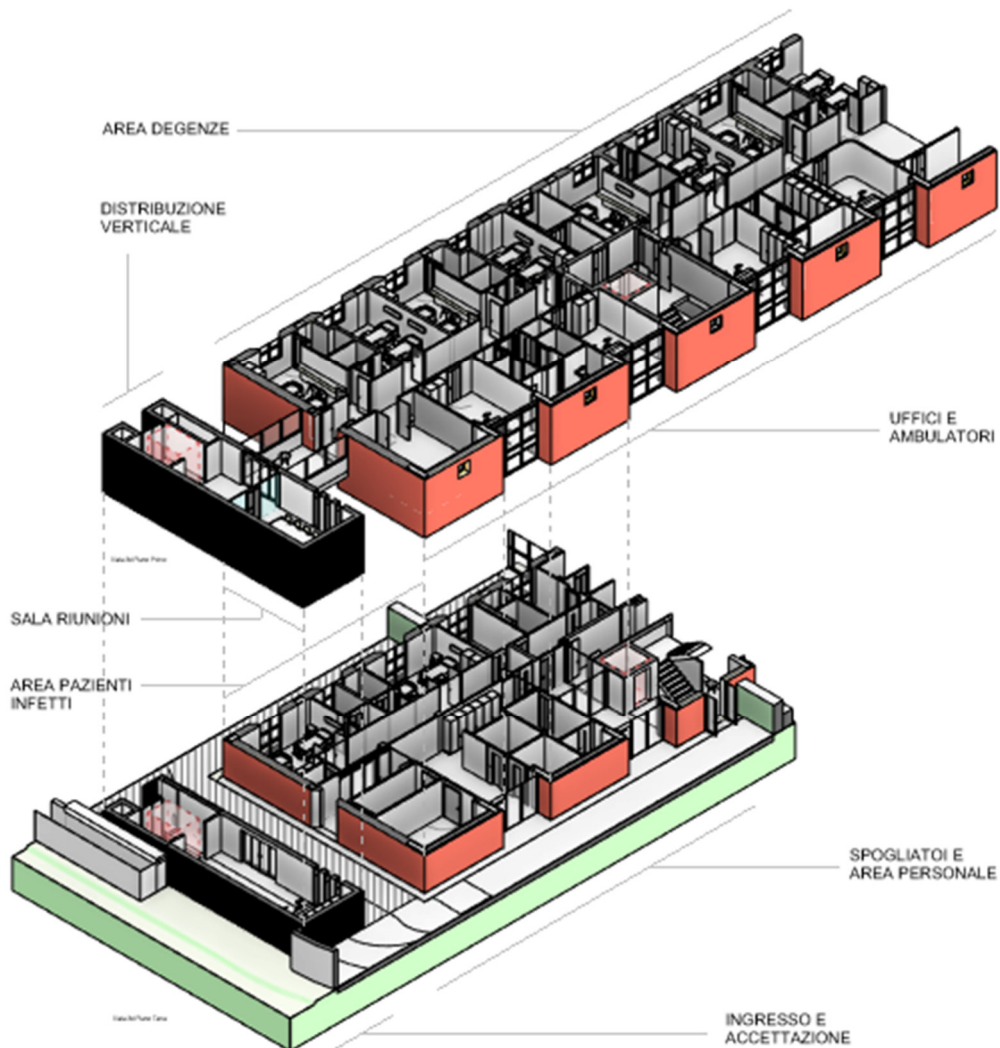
Esploso tridimensionale dell'intervento di progetto
